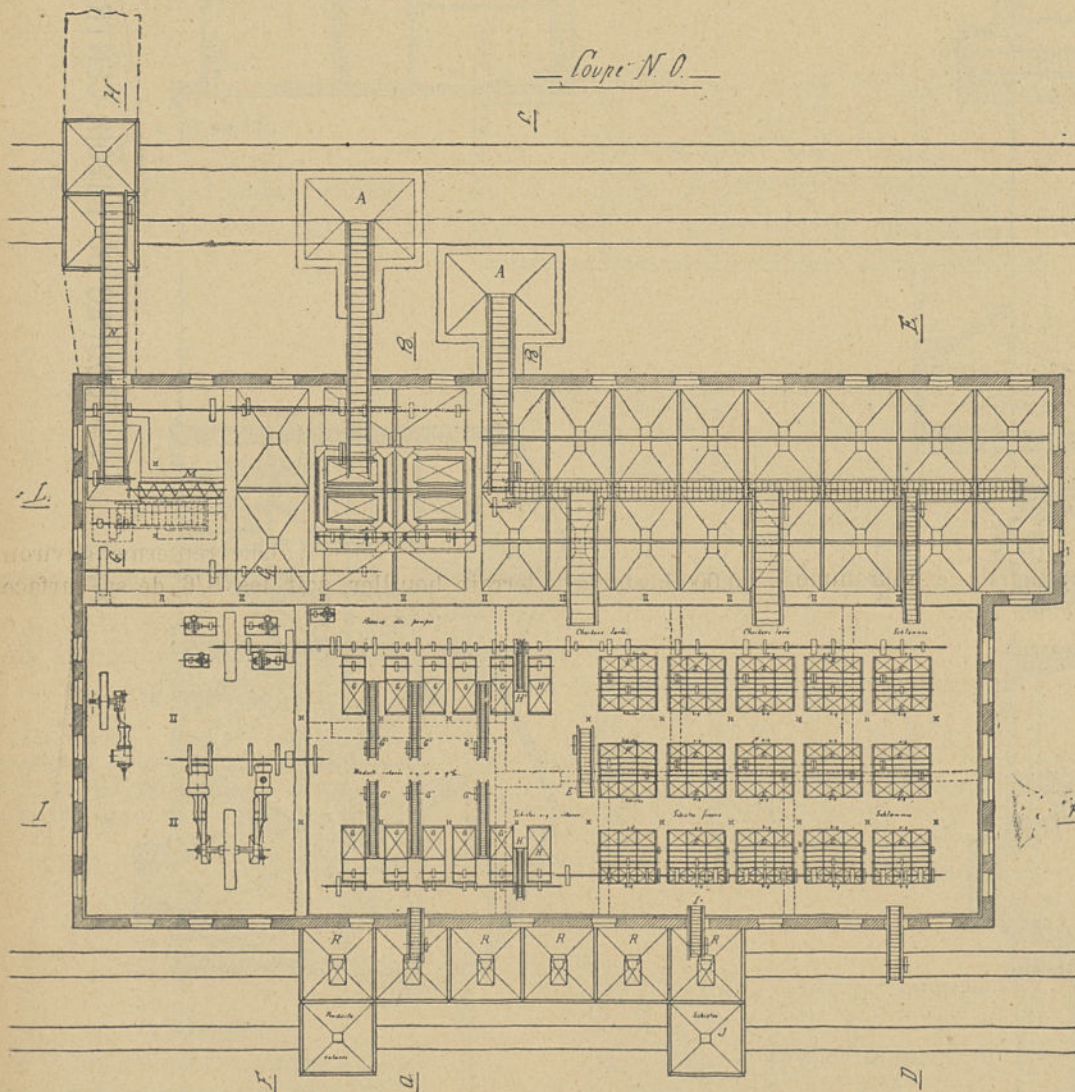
Coupe horizontale du lavoir central d'Aniche.
